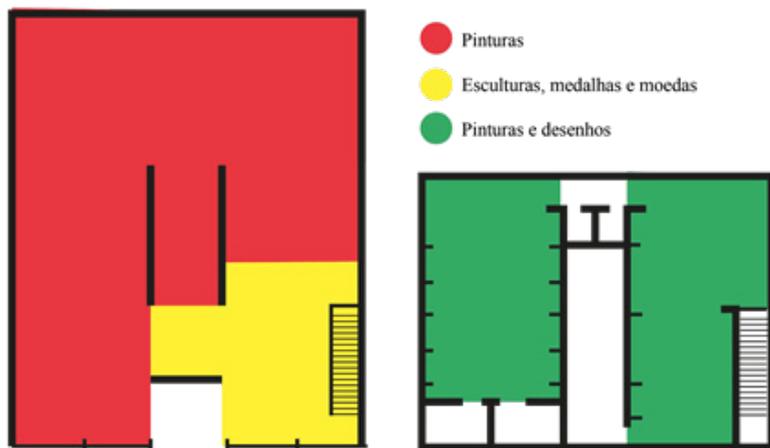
Esquema das plantas do pavimento térreo e do primeiro pavimento com demarcação das áreas de exposição do museu. Fonte: Autor, 2021.
